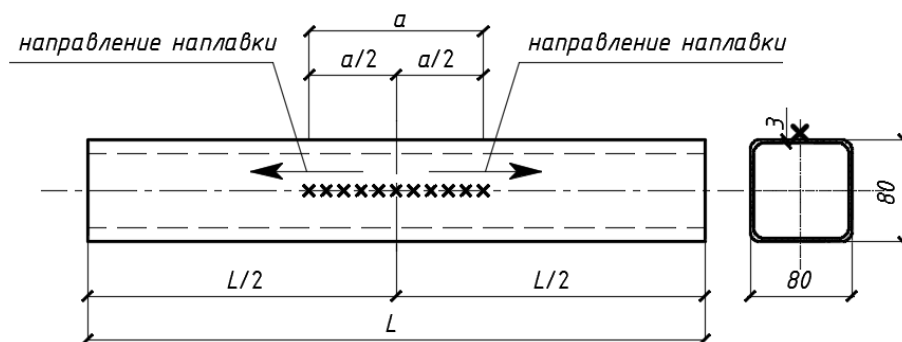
Схема расположения и направления наплавки холостых валиков стальных конструкций из труб квадратного сечения
